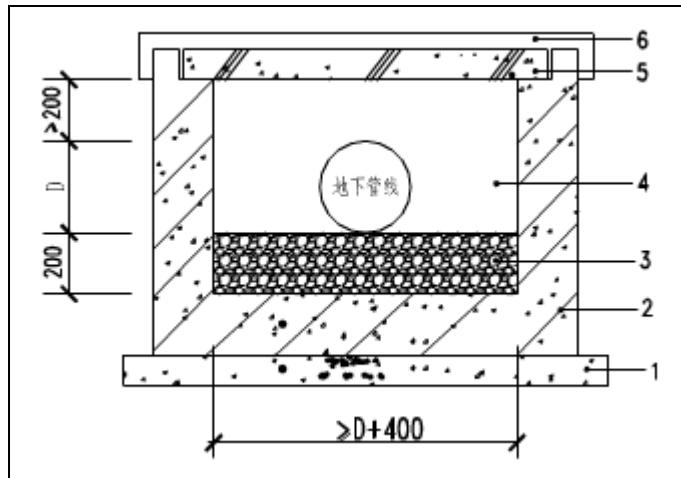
抗渗钢筋混凝土管沟防渗层示意图
